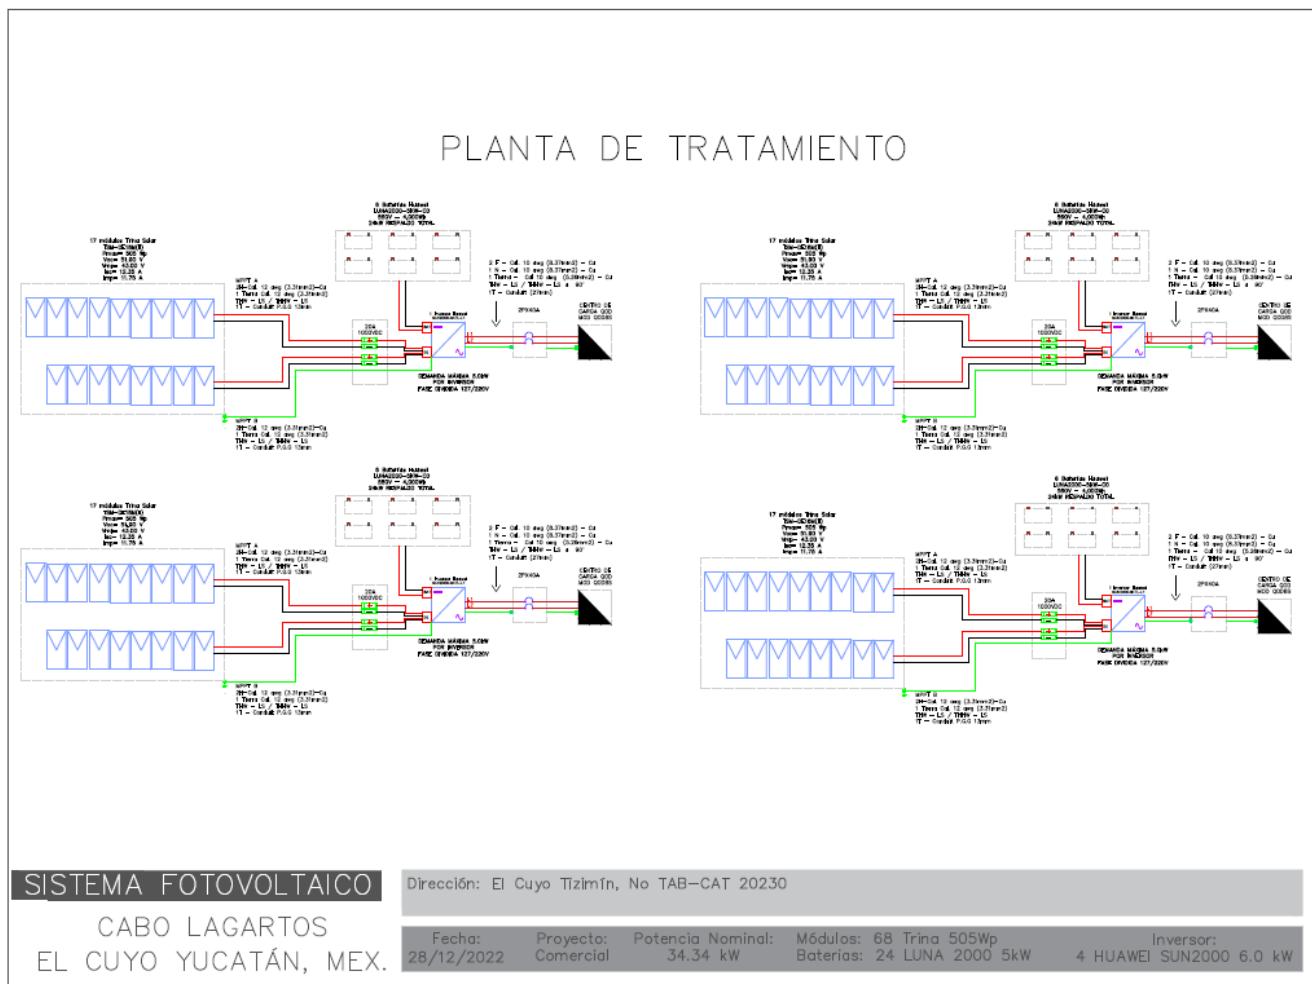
Sistema fotovoltaico de la planta de tratamiento.
